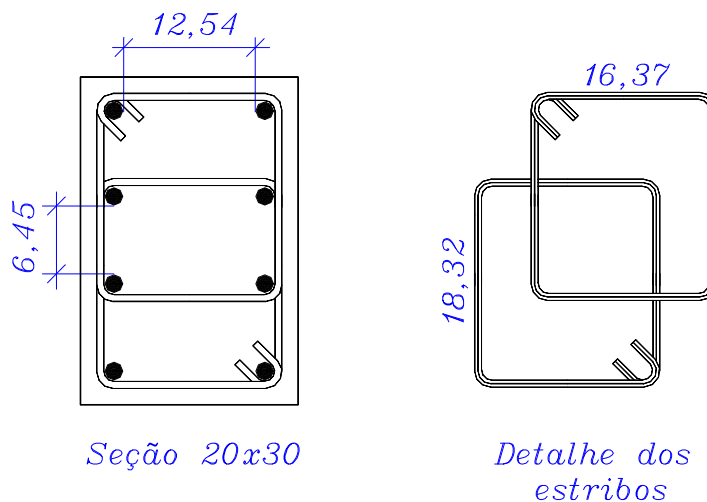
Arranjo inicial de armaduras para o pilar P1
